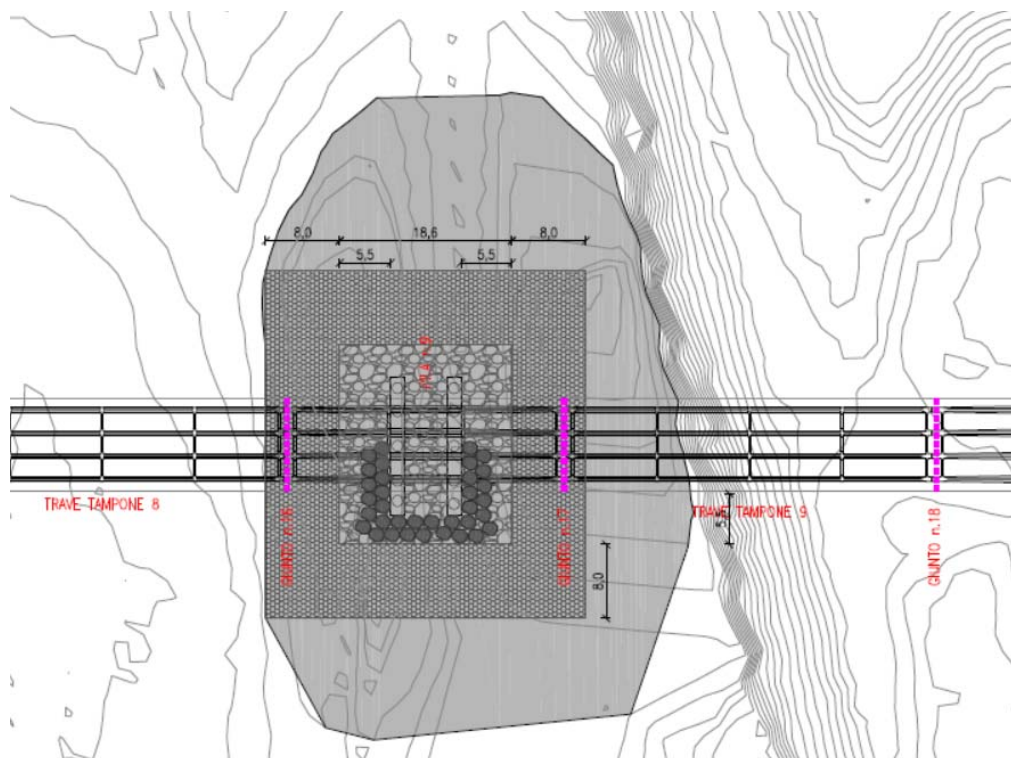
estratto planimetrico dell'intervento nell'intorno della pila 9
